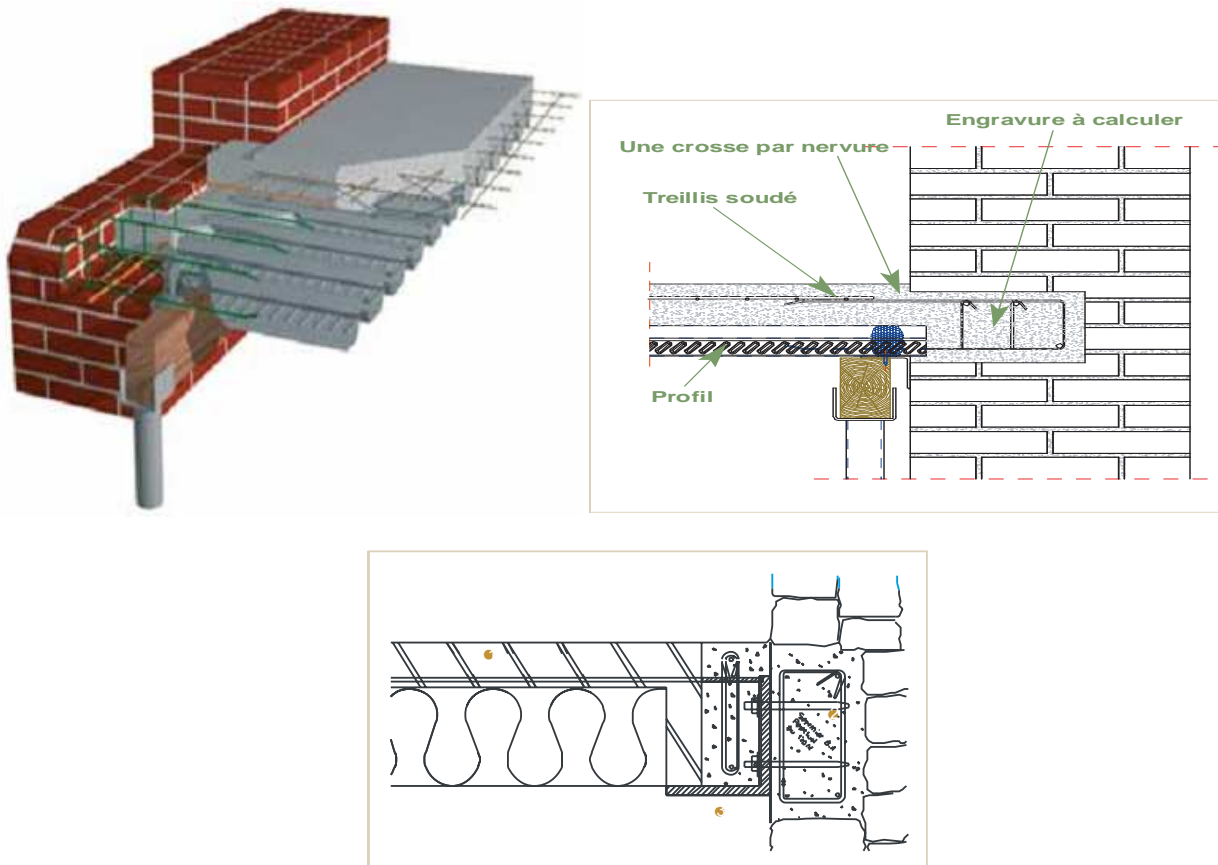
Appui de plancher dans un mur en maçonnerie
